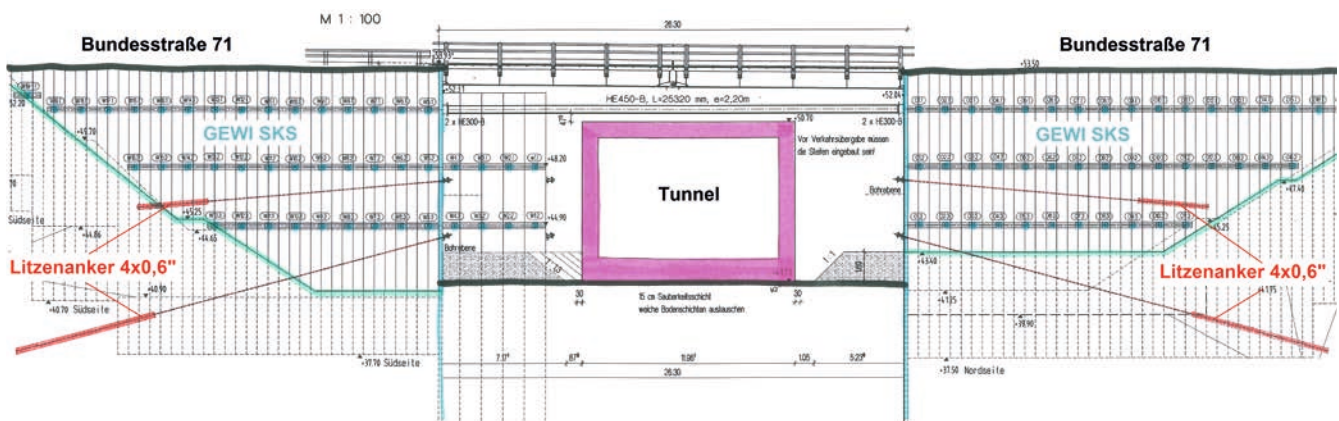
Schnitt durch Straßendamm mit Tunnelbauwerk
